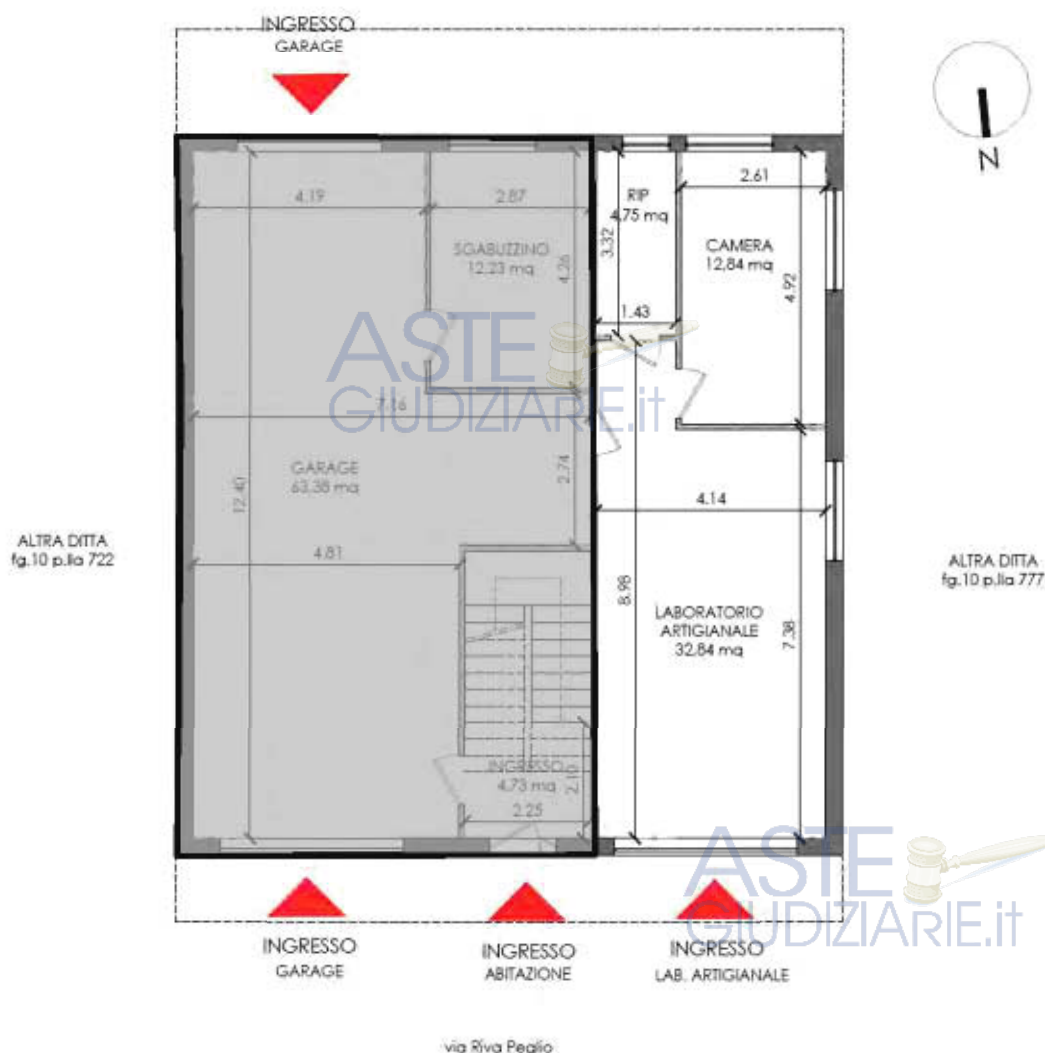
Rilievo Stato di fatto Lotto 2, Laboratorio per Arti e Mestieri_ pianta piano terra (Allegato 6D)
